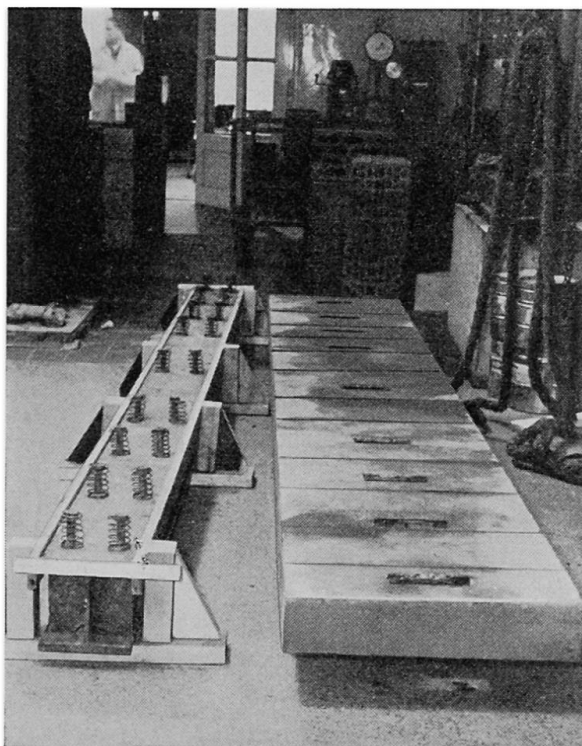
Fertigbetonplatte und Stahlträger vor dem Zusammenbau.
